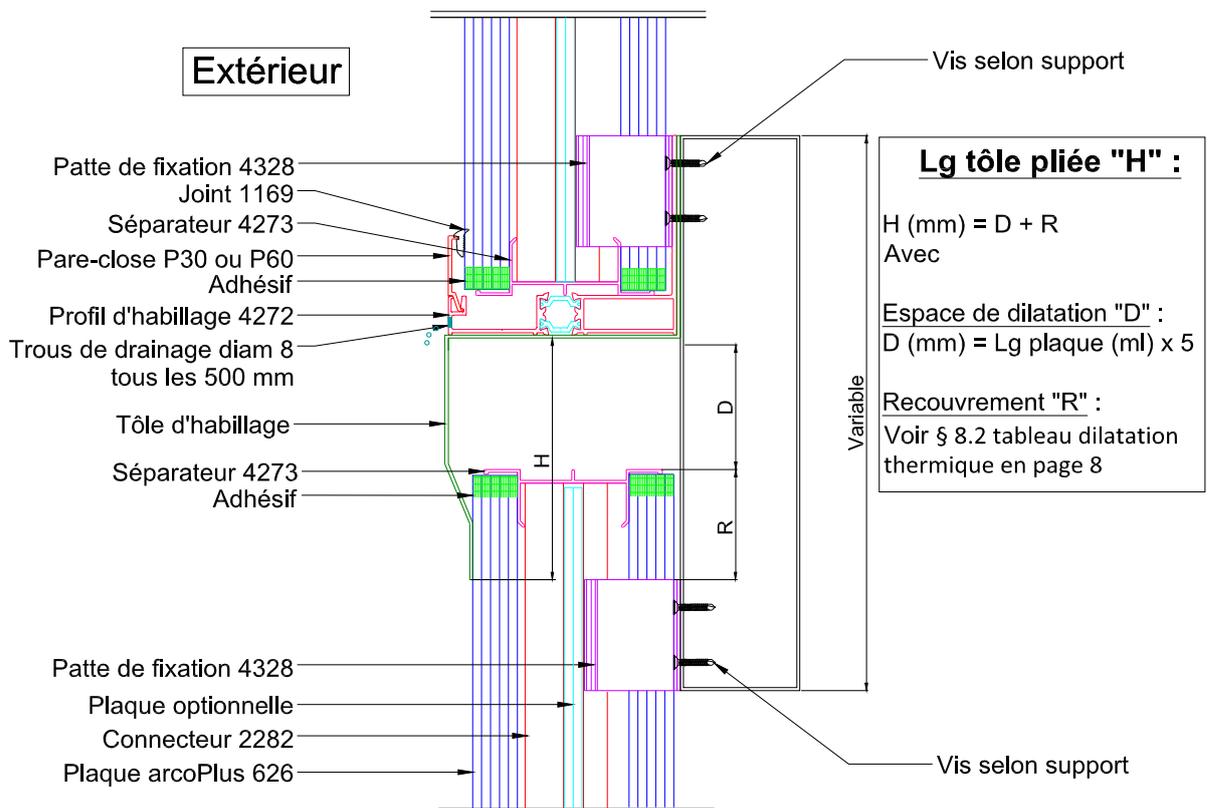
Raccord de hauteur n°3 : façade basse limitée à 16 mètres de haut -
